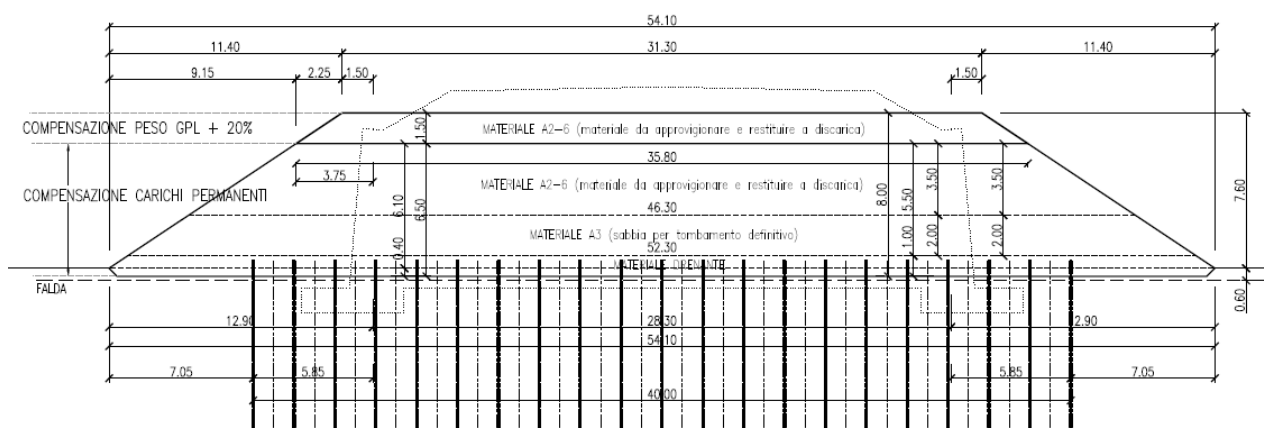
Sezione trasversale rilevato di pre-carico.
